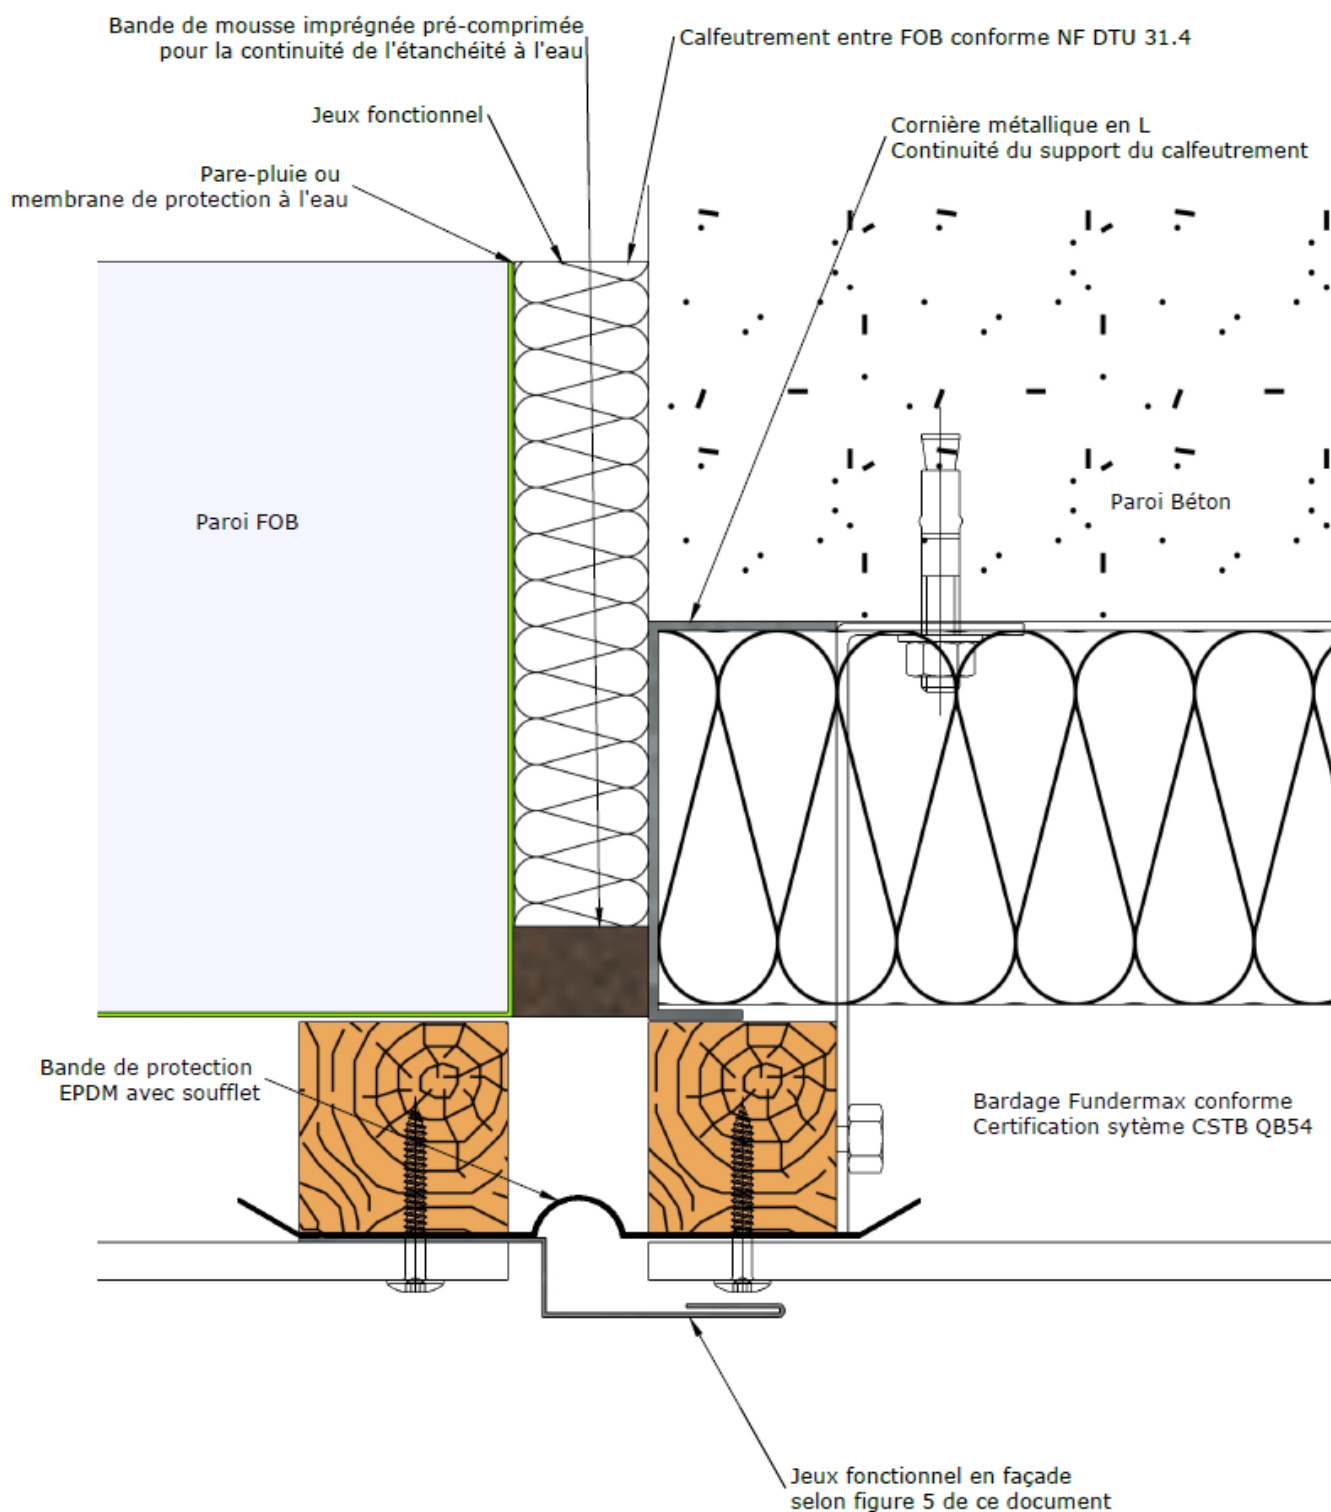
Jeu fonctionnel vertical Ee2 entre une FOB et un voile béton, coupe horizontale
